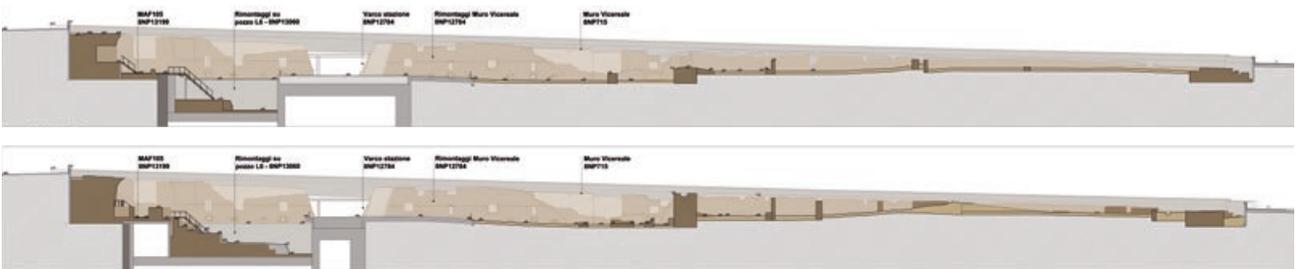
Sezione longitudinale guardando il muro della seconda cinta muraria vicereale del XVI sec.
